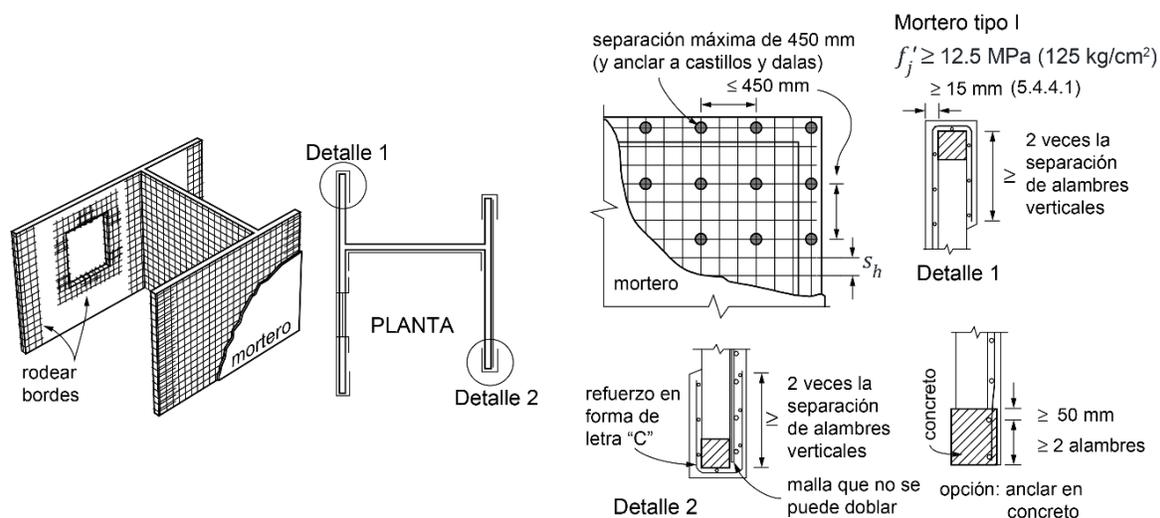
d) Refuerzo con malla de alambre soldado y recubrimiento de mortero.
